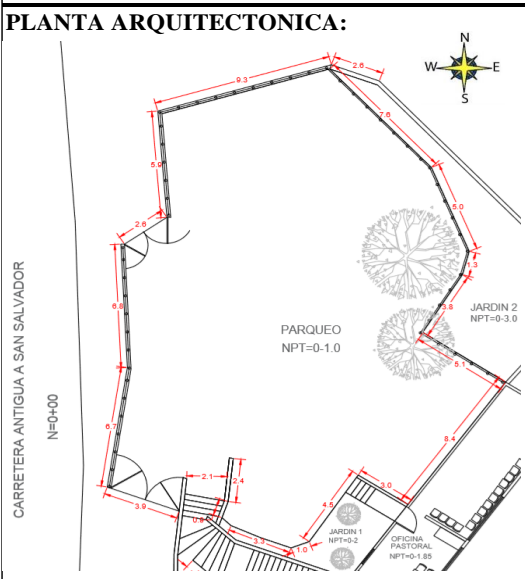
Planta arquitectónica del parqueo. Elaboración propia.
